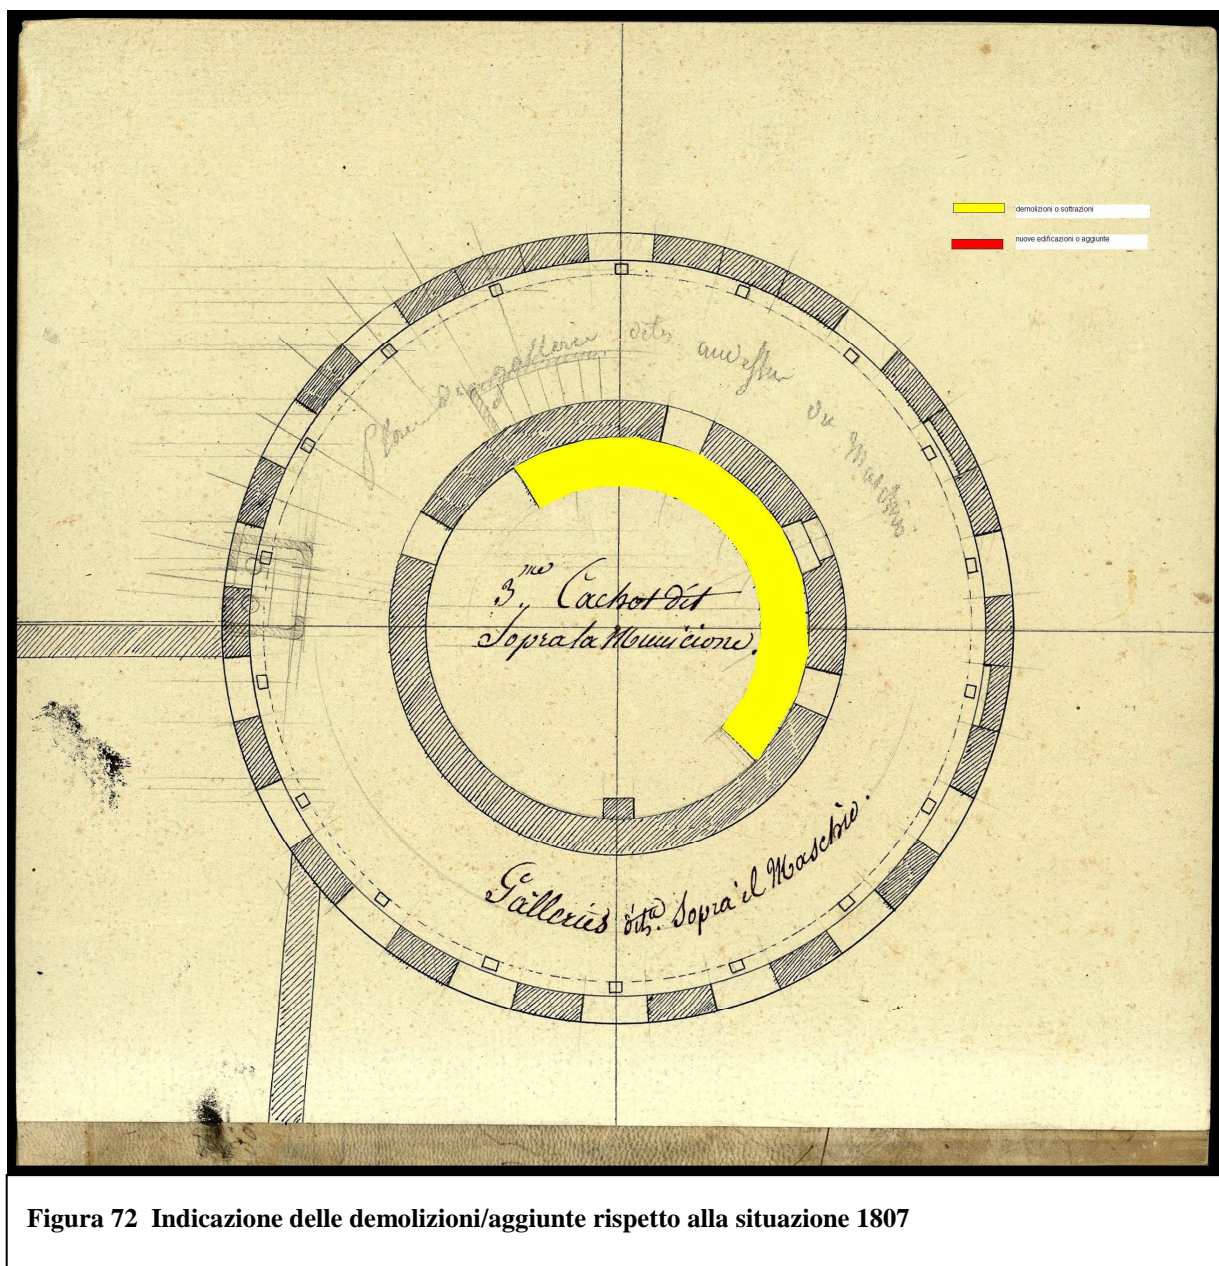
Indicazione delle demolizioni/aggiunte rispetto alla situazione 1807
